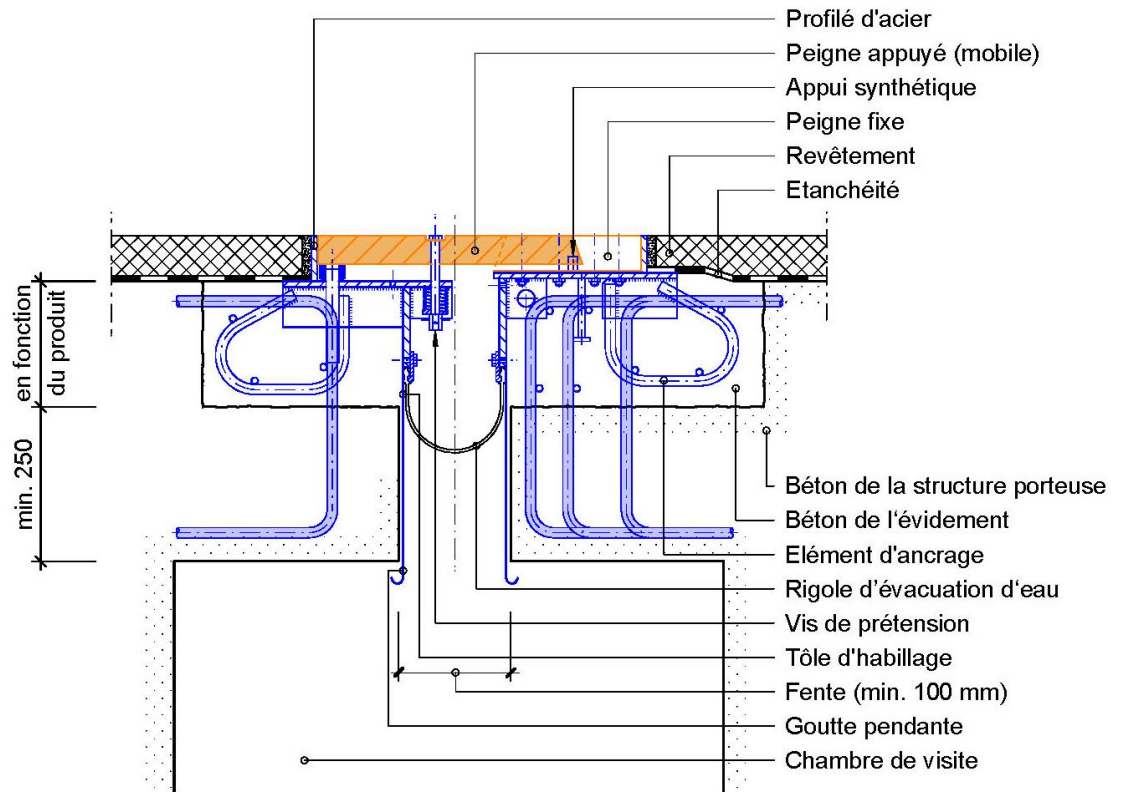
Coupe schématique d'un joint de chaussée à peigne appuyé.
